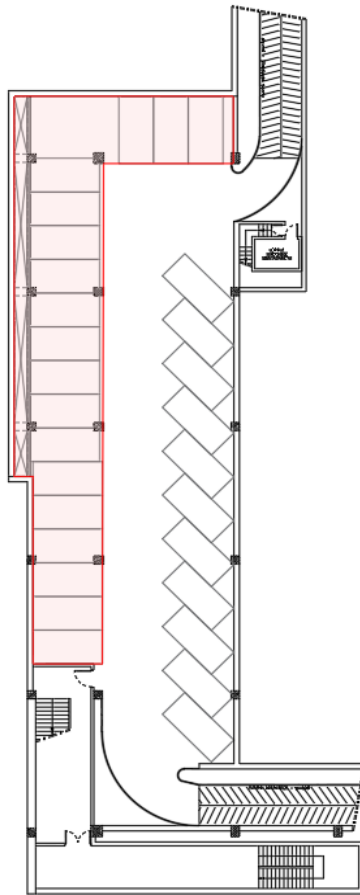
Rappresentazione planimetrica del subalterno 40 (mq 295 circa)
